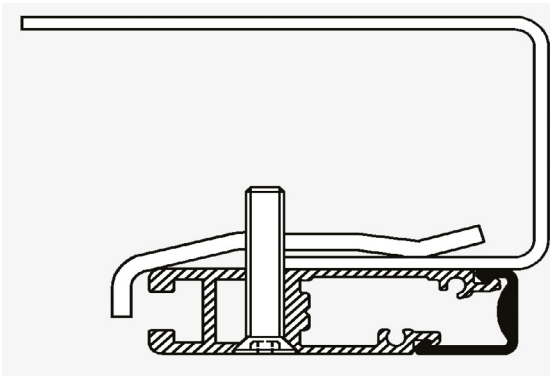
Perfil de 10mm instalado con las pinzas de fijación C2510 803
